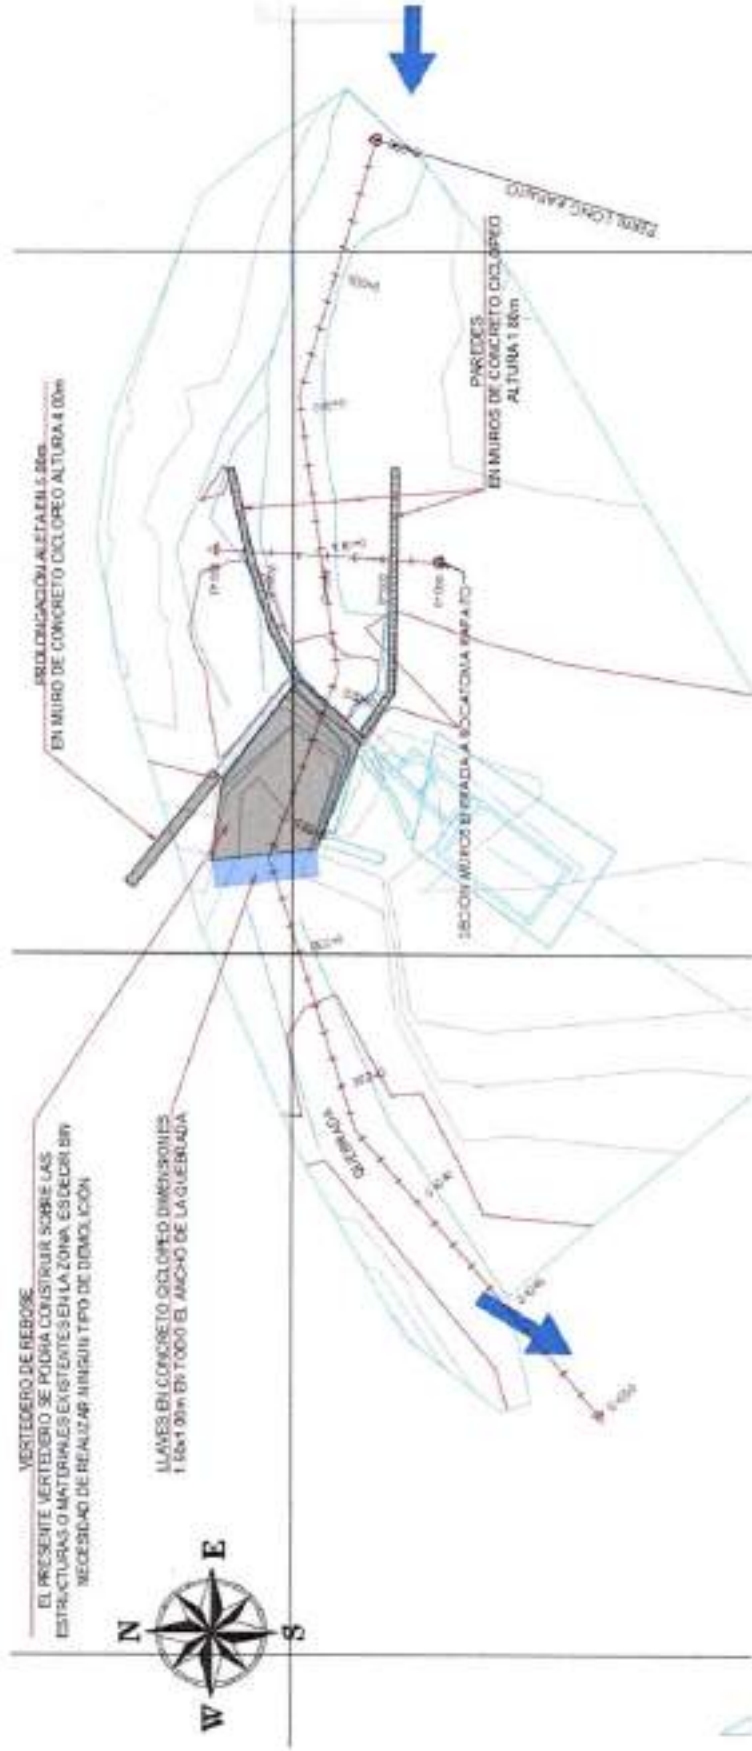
Obras propuestas bocatomas Los Cano – perfil longitudinal y sección transversal quebrada
